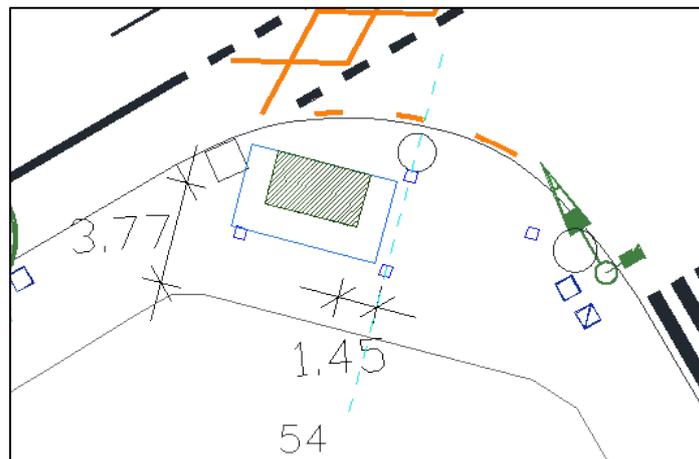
Esquema en planta del subtramo. Fuente: Elaboración propia.
